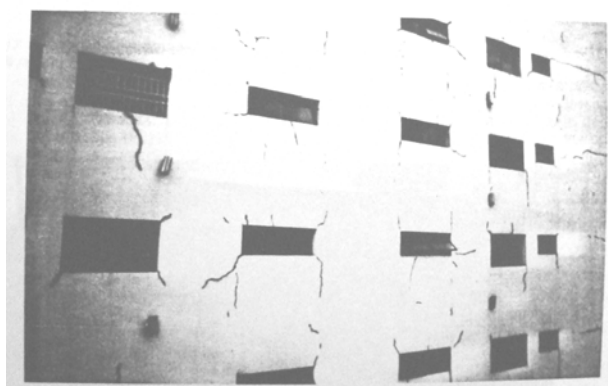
Fissuração generalizada causada pela retração dos componentes da alvenaria e pelo grande número de janelas na parede
